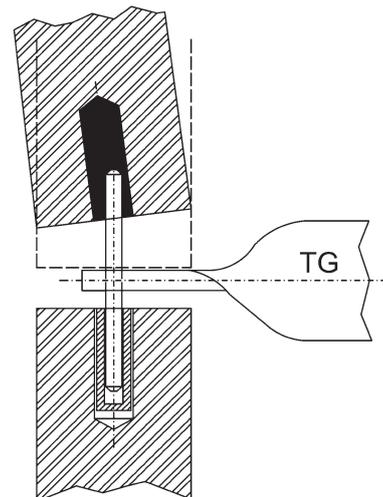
Austausch einer Fassadenplatte mit Anker in der horizontalen Fuge.
